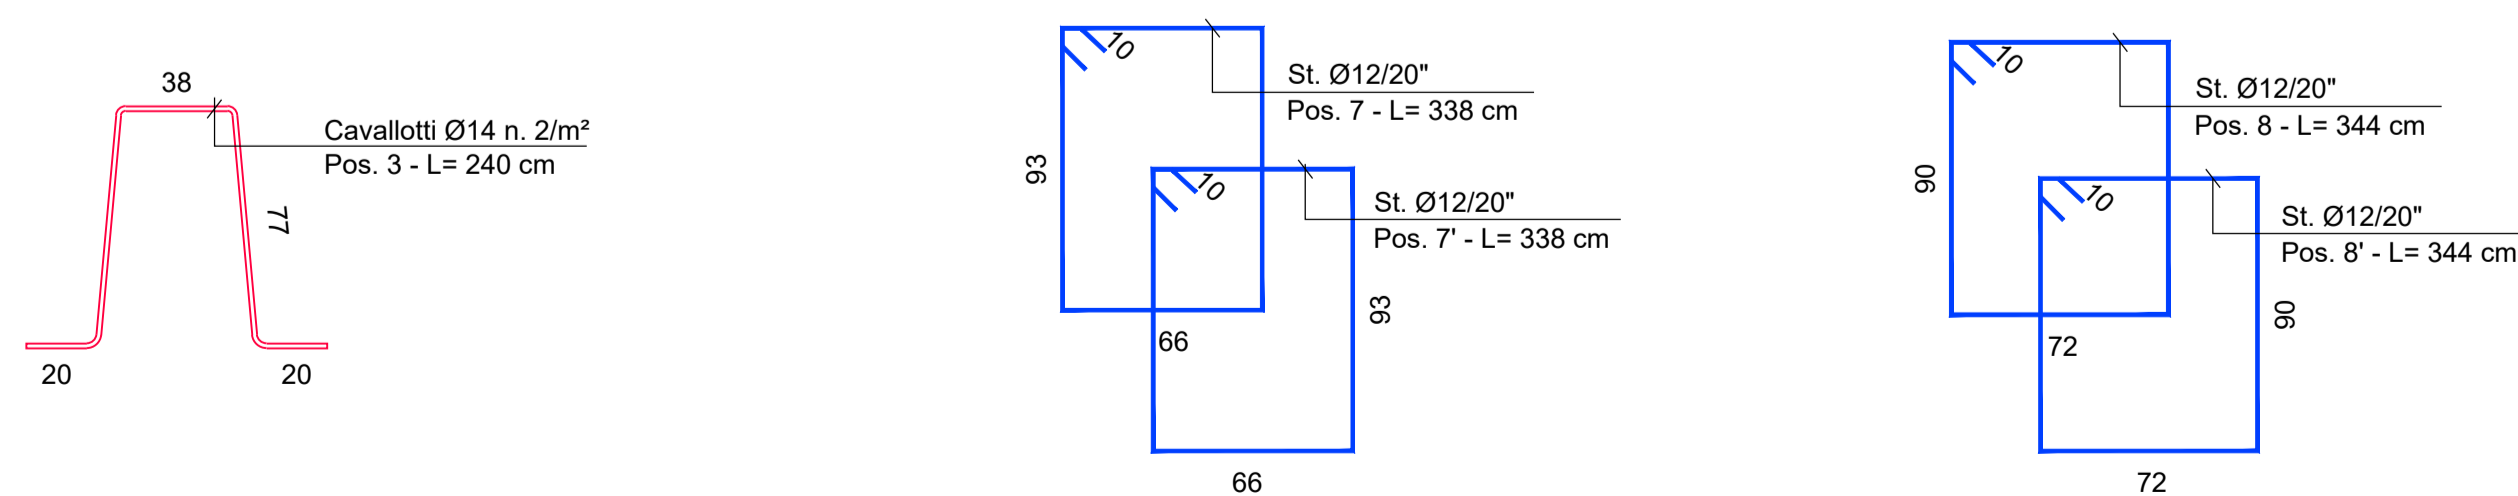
# PLATEA IN C.A. STRALCIO PIANTA ARMATURA
